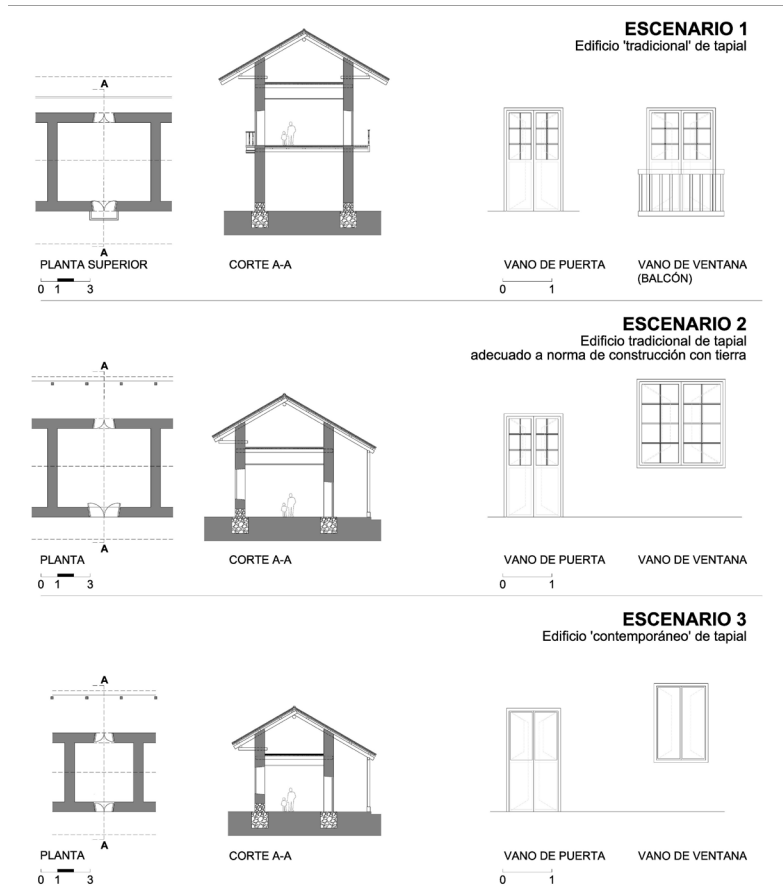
Detalle en planta y en corte de los tres escenarios a analizar, además de las características de los vanos y de la carpintería de madera en cada uno de ellos. Fuente: Martín Wieser.
